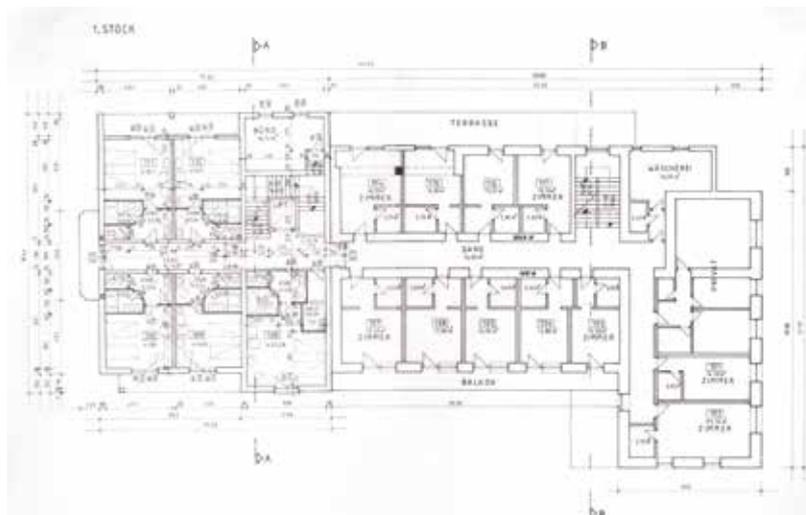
Waldhofhotel: Grundriss 1.OG
